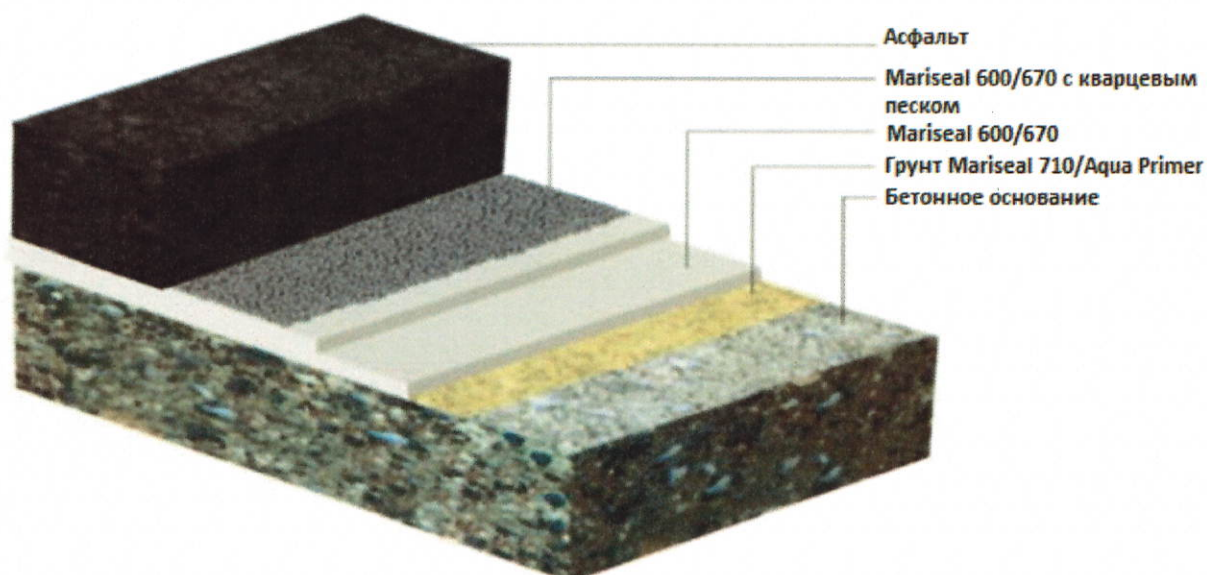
Устройство дорожной одежды с использованием гидроизоляционных материалов MARISEAL® для бетонных оснований
